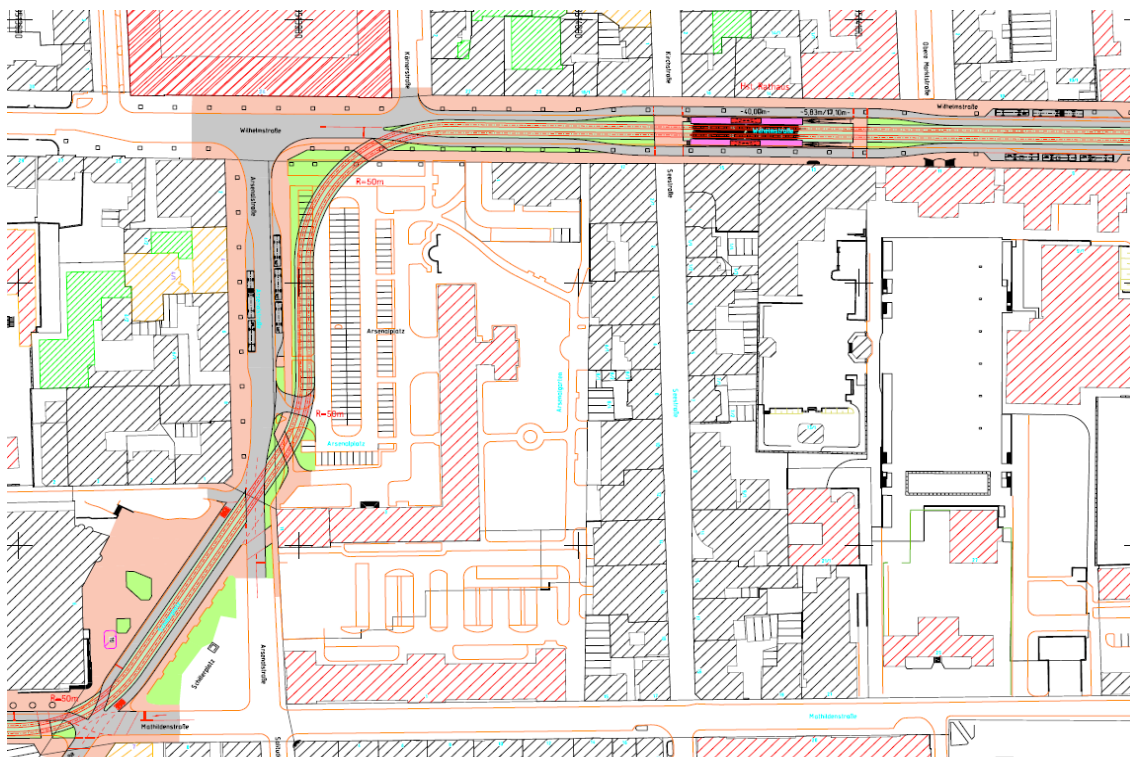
Lageplan Bereich Arsenalplatz
